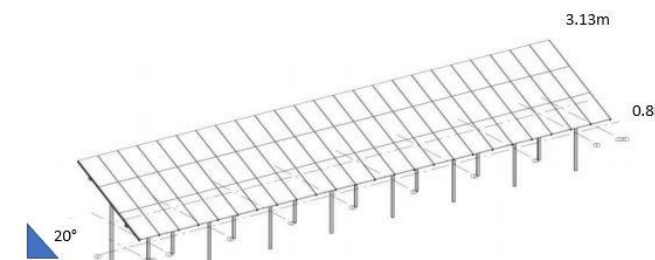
Exemple du type de fondation et d'ancrage par pieux battus
